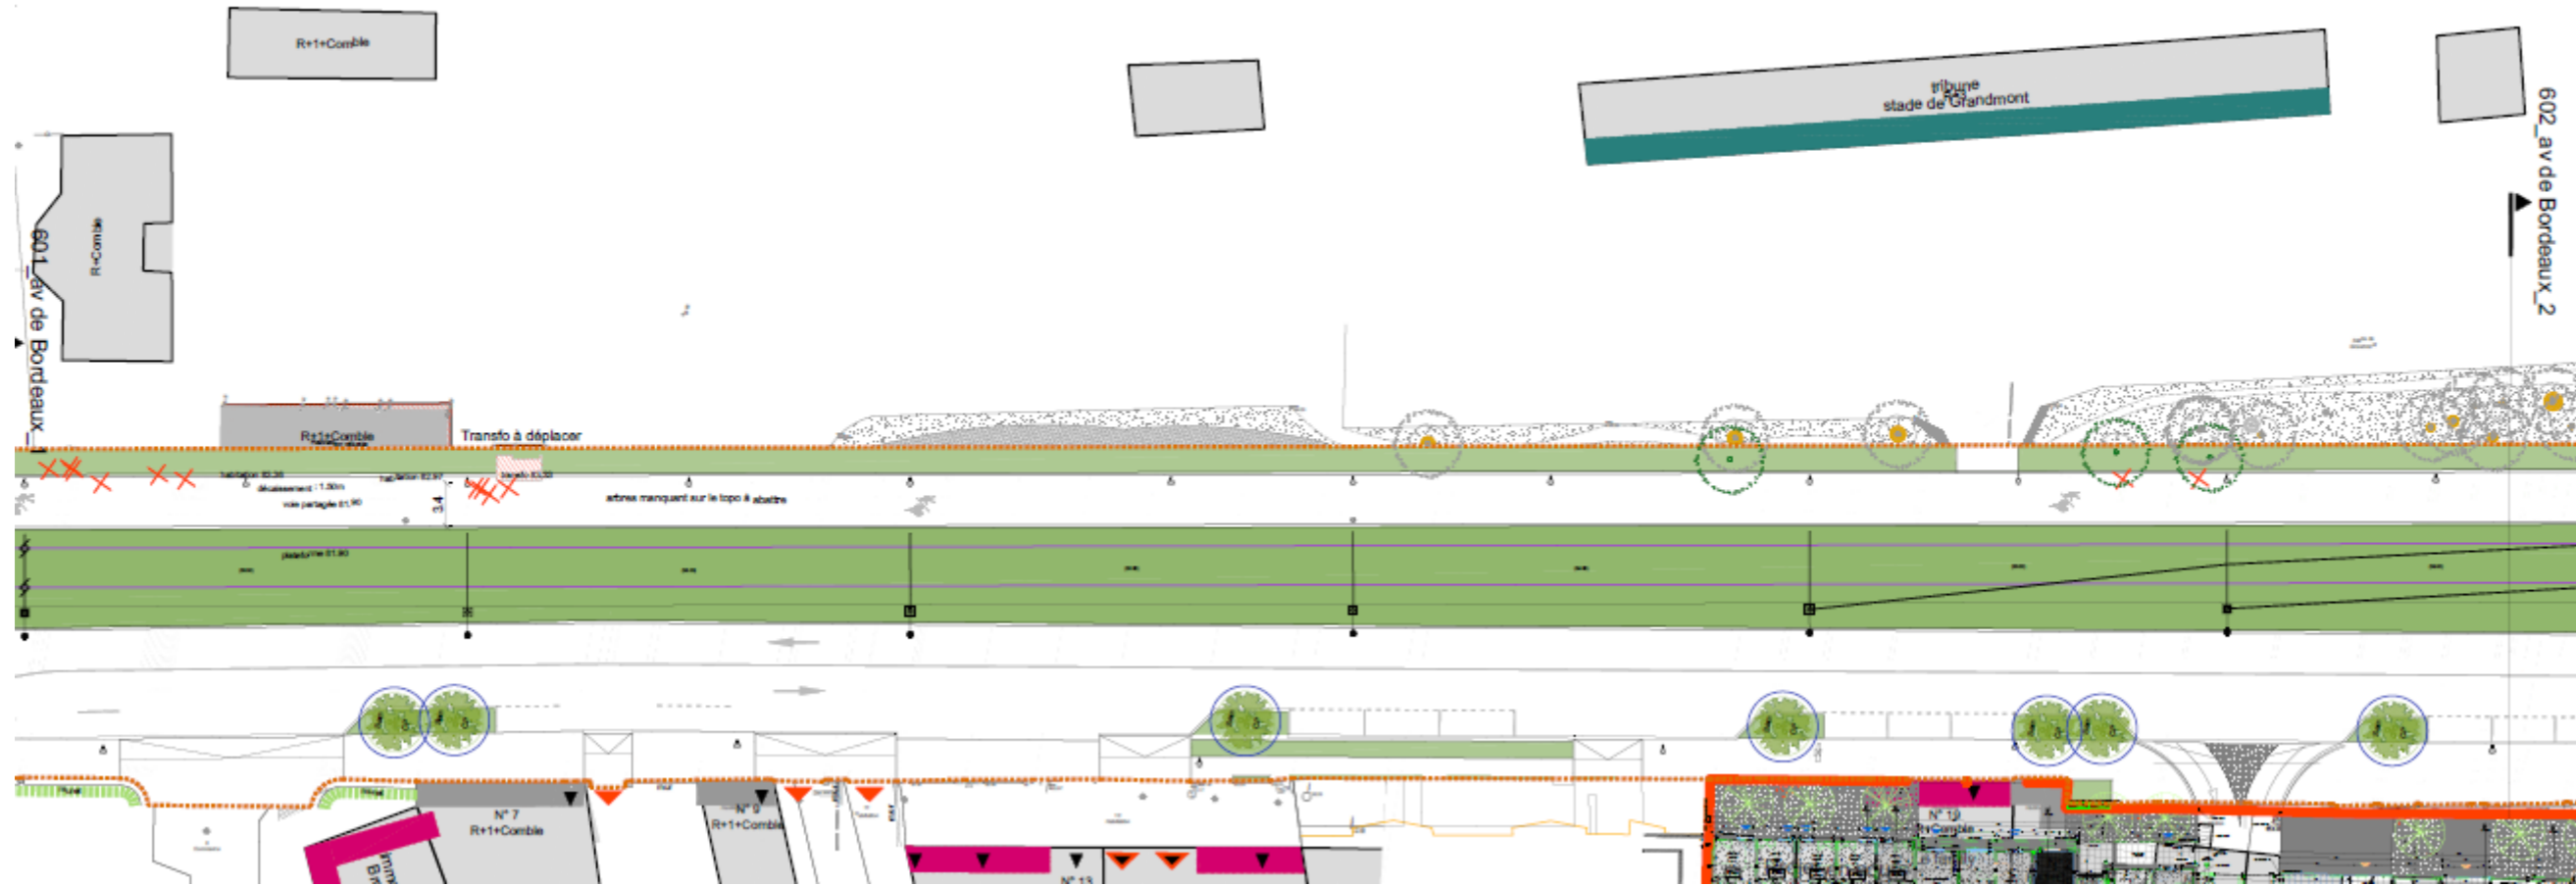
extrait du plan masse sur le secteur avenue de Bordeaux (côté Est)
